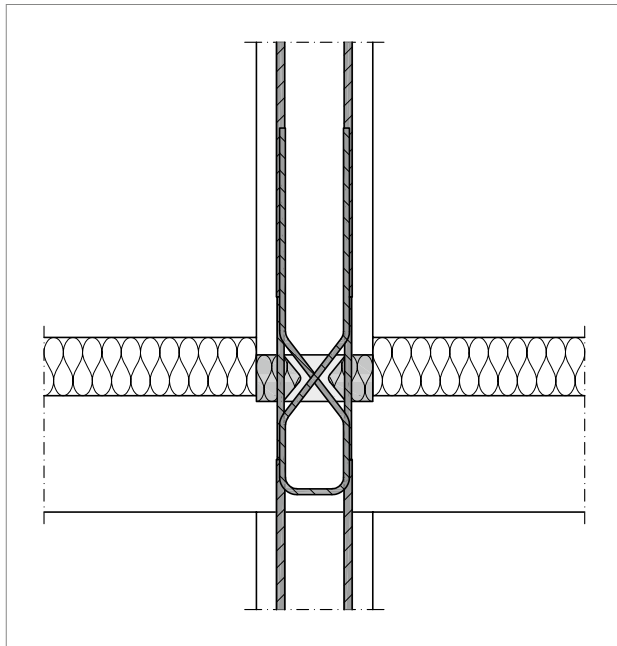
Schöck Sconnex® type W: Gecombineerde productvarianten voor de aansluiting van een horizontaal belaste, stabiliserende wand
